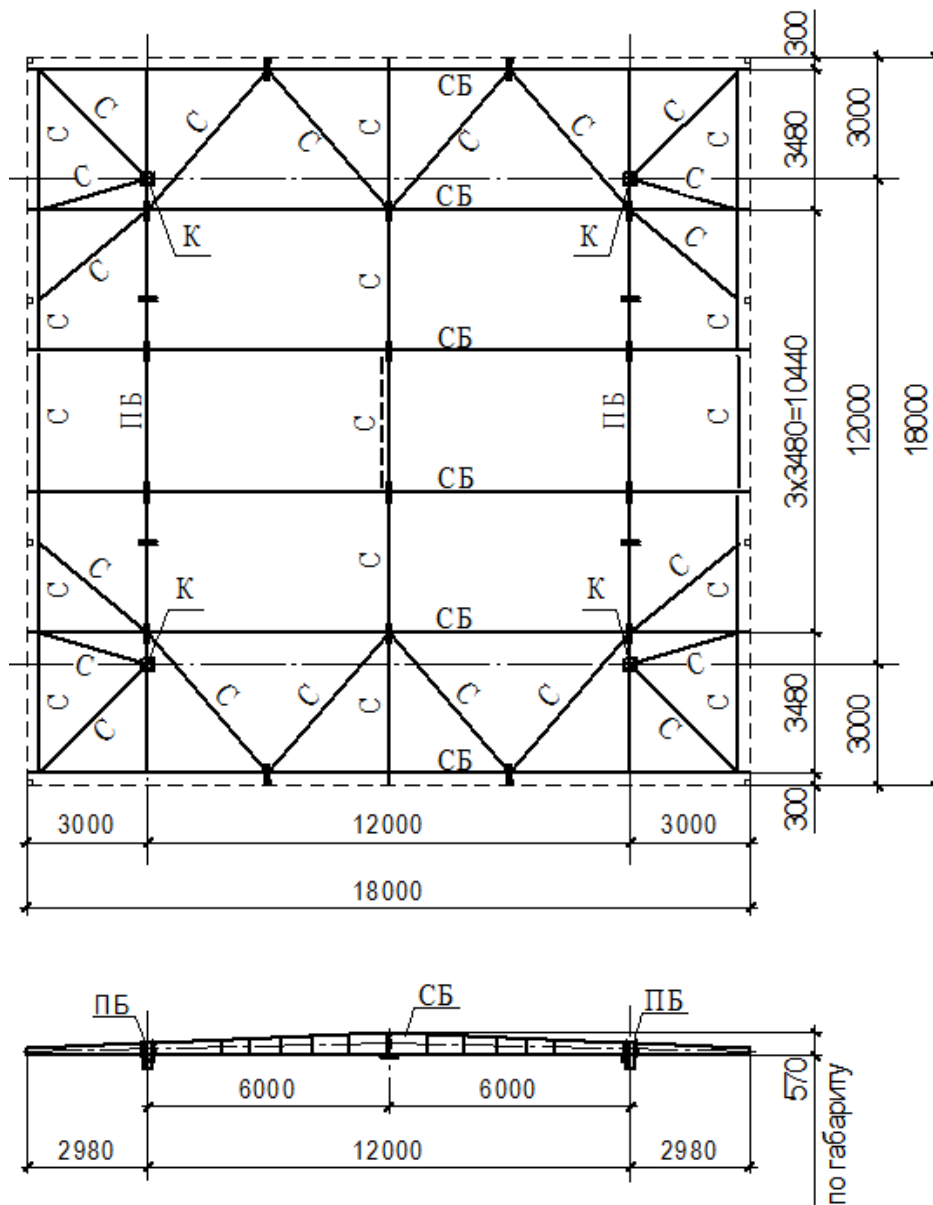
Схема покрытия по первому варианту со стропильными и подстропильными балками
